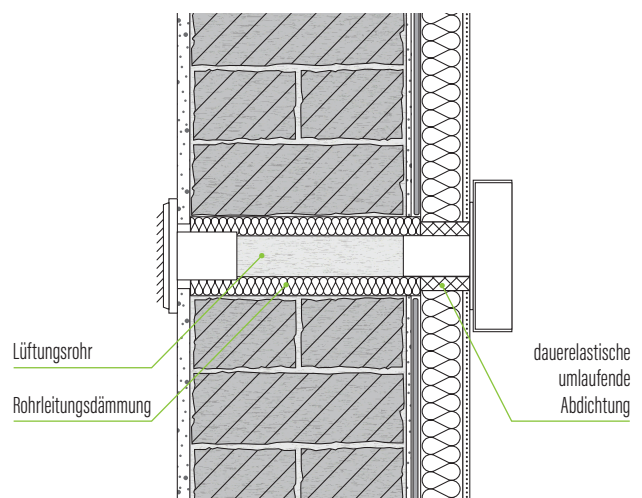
Einbaubeispiel einer Wanddurchdringung
